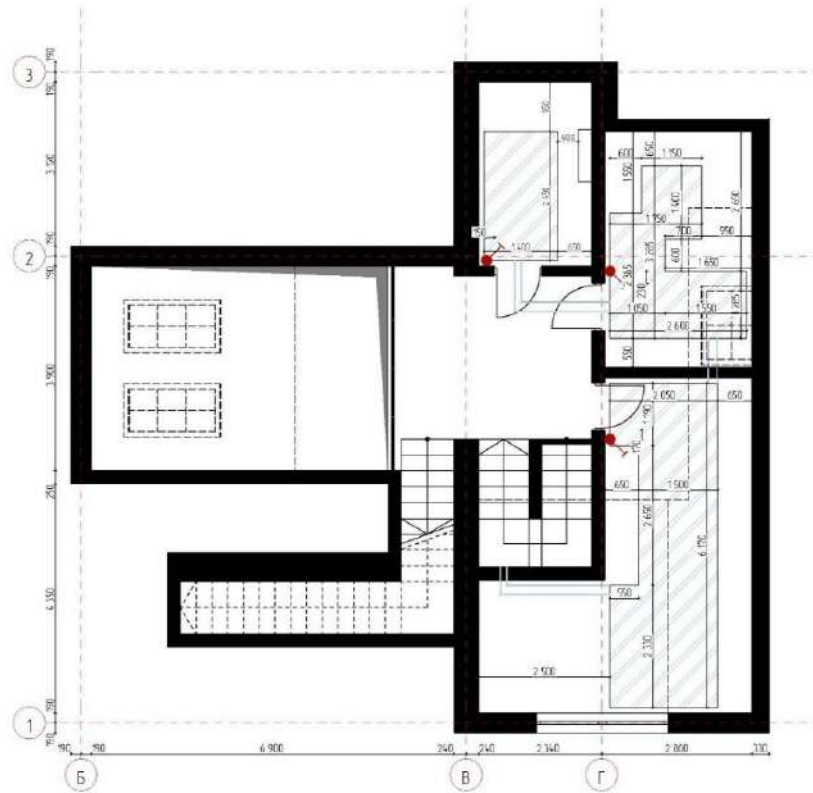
План розміщення водяної теплої пілоги 2-го поверху (авторське креслення).
